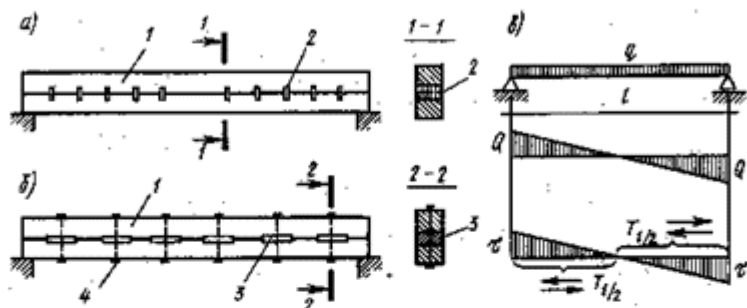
Складені брущаті балки на податливих з'єднаннях:
